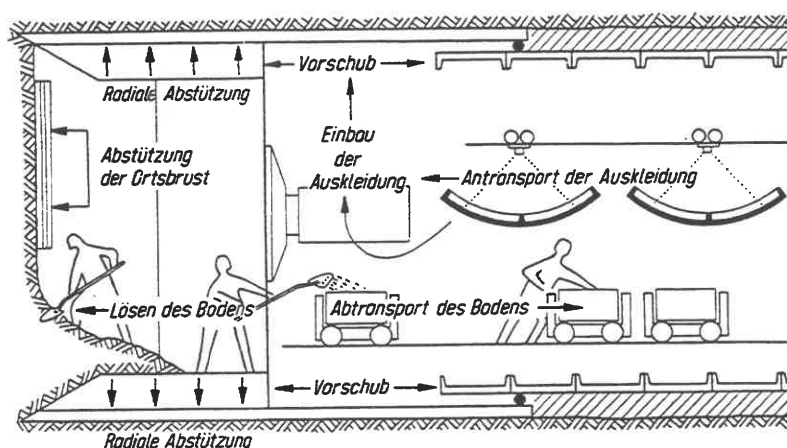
Tunnelbau mit Handschild (KRABBE 1971)
